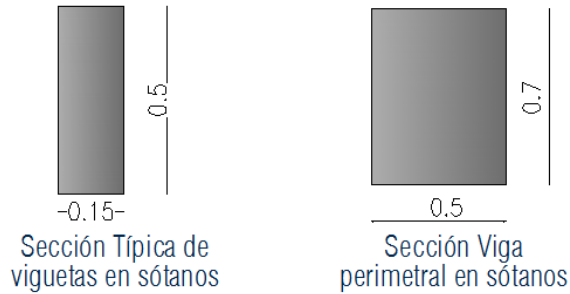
Sección típica de viguetas y viga perimetral en Sótanos
